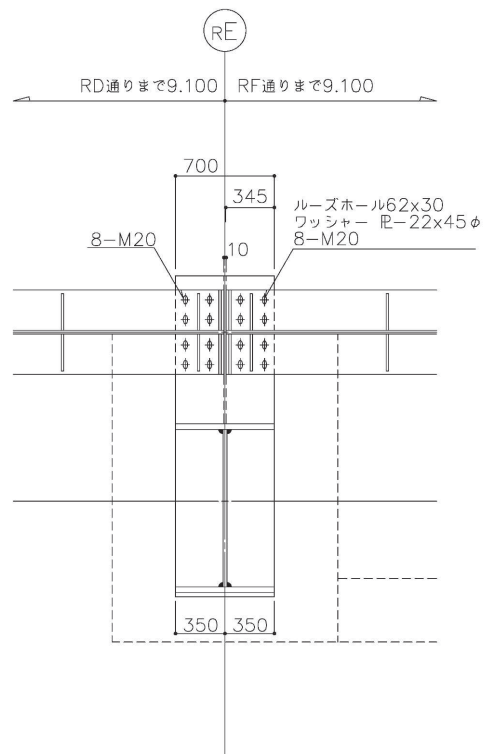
(2) クレーンガーダ鉄骨の平面図及び断面図 (2/3)
